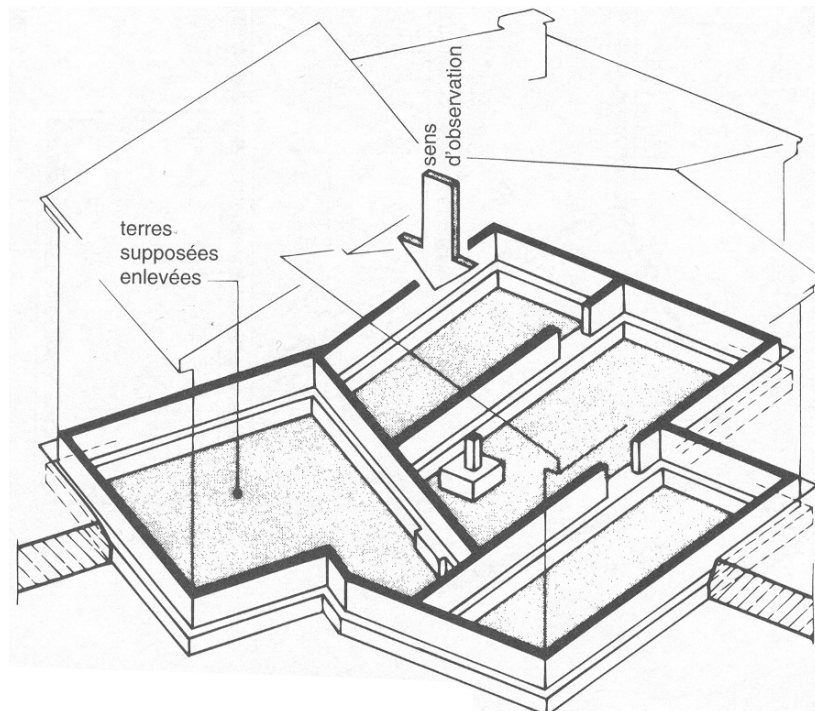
PRINCIPE D'OBTENTION D'UN PLAN DE FONDATION
